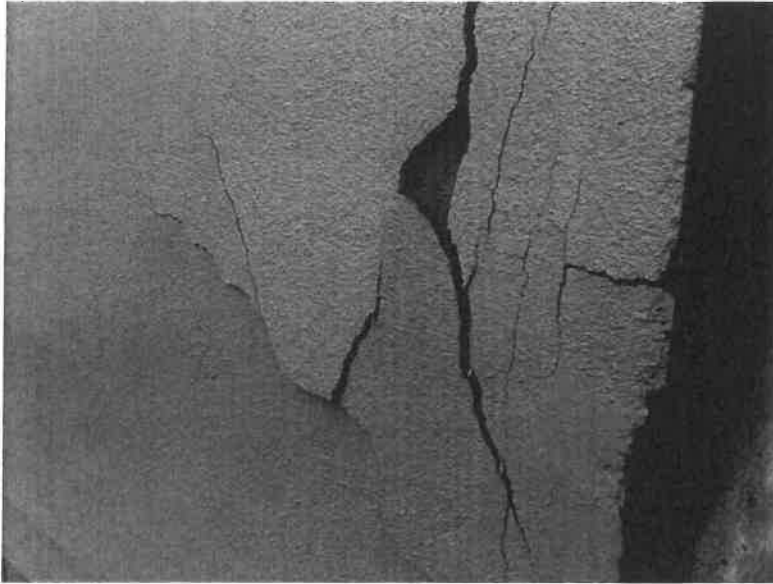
Rendsburg, Kirchenstraße 10, Detailansicht
